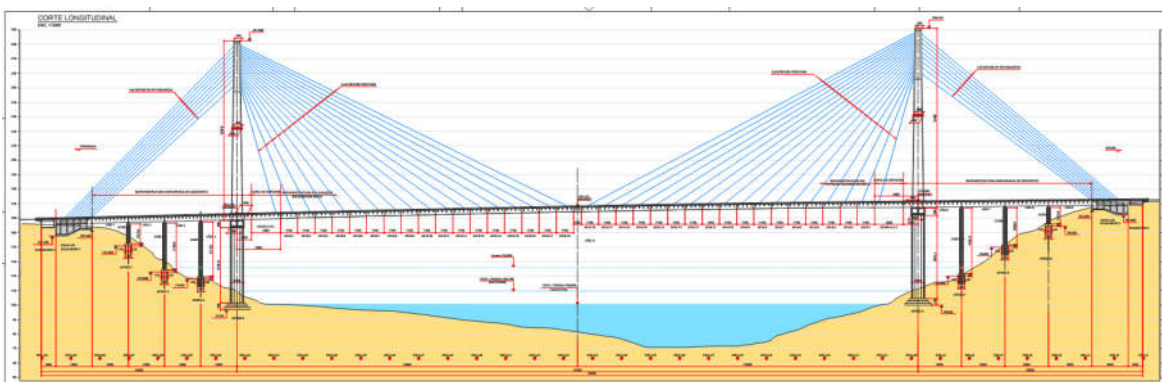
Projeto de Obra de Arte Especial - Ponte Estaiada. Fonte: Consórcio Construbase-Paulitec, 2016.
